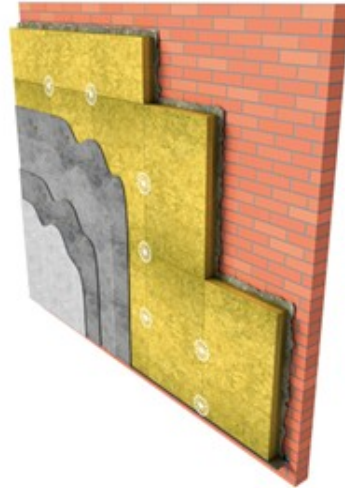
Fachada SATE, 2014. ROCKWOOL
